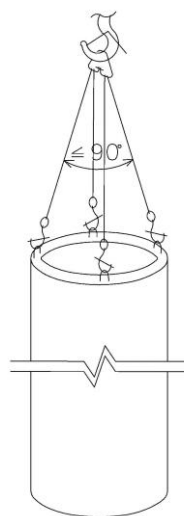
Схема строповки металлической трубы для трубобетонных колонн
